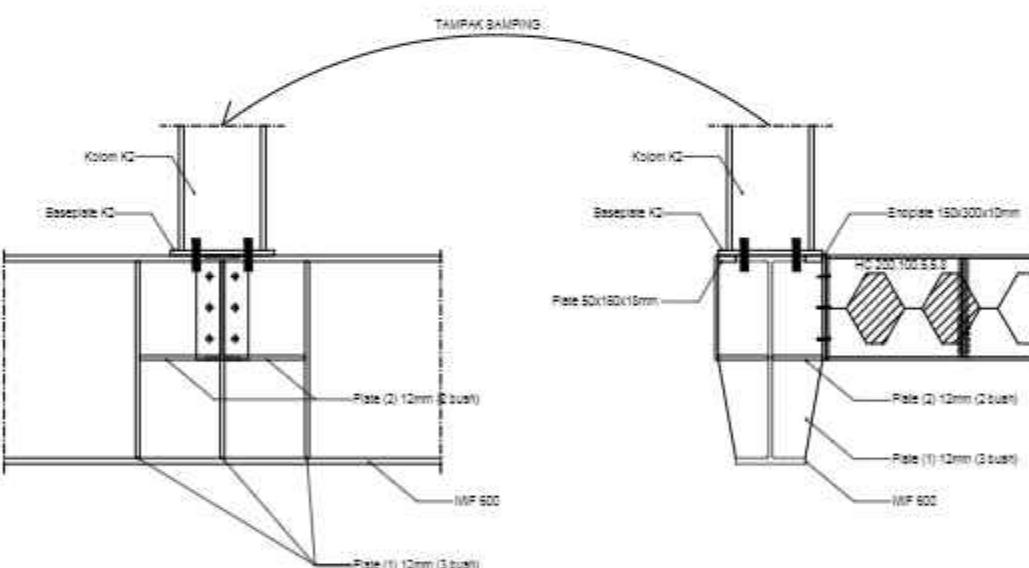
DETAIL HUB KOLOM K1 DUDUK DI BALOK IWF 600 (1)
